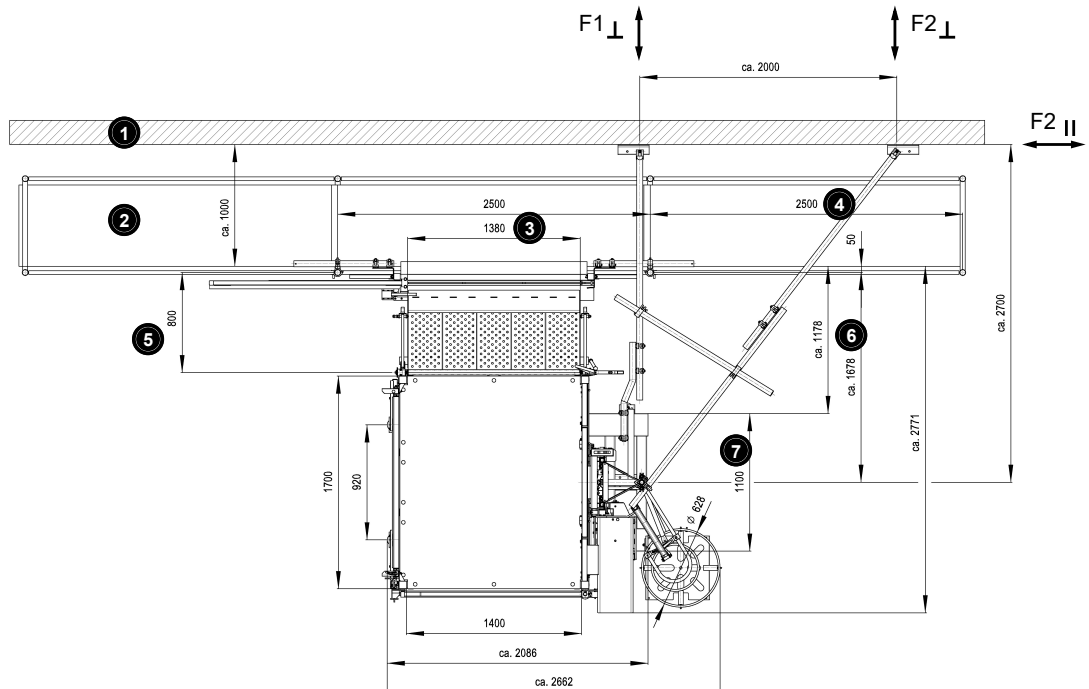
Verankerung vor Gerüst (Angaben in mm)
